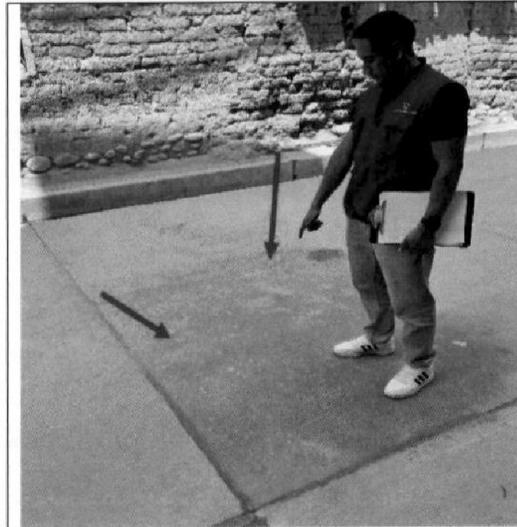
Grieta en pavimento rígido en la intersección del jirón Leoncio Prado y jirón Espinar.
